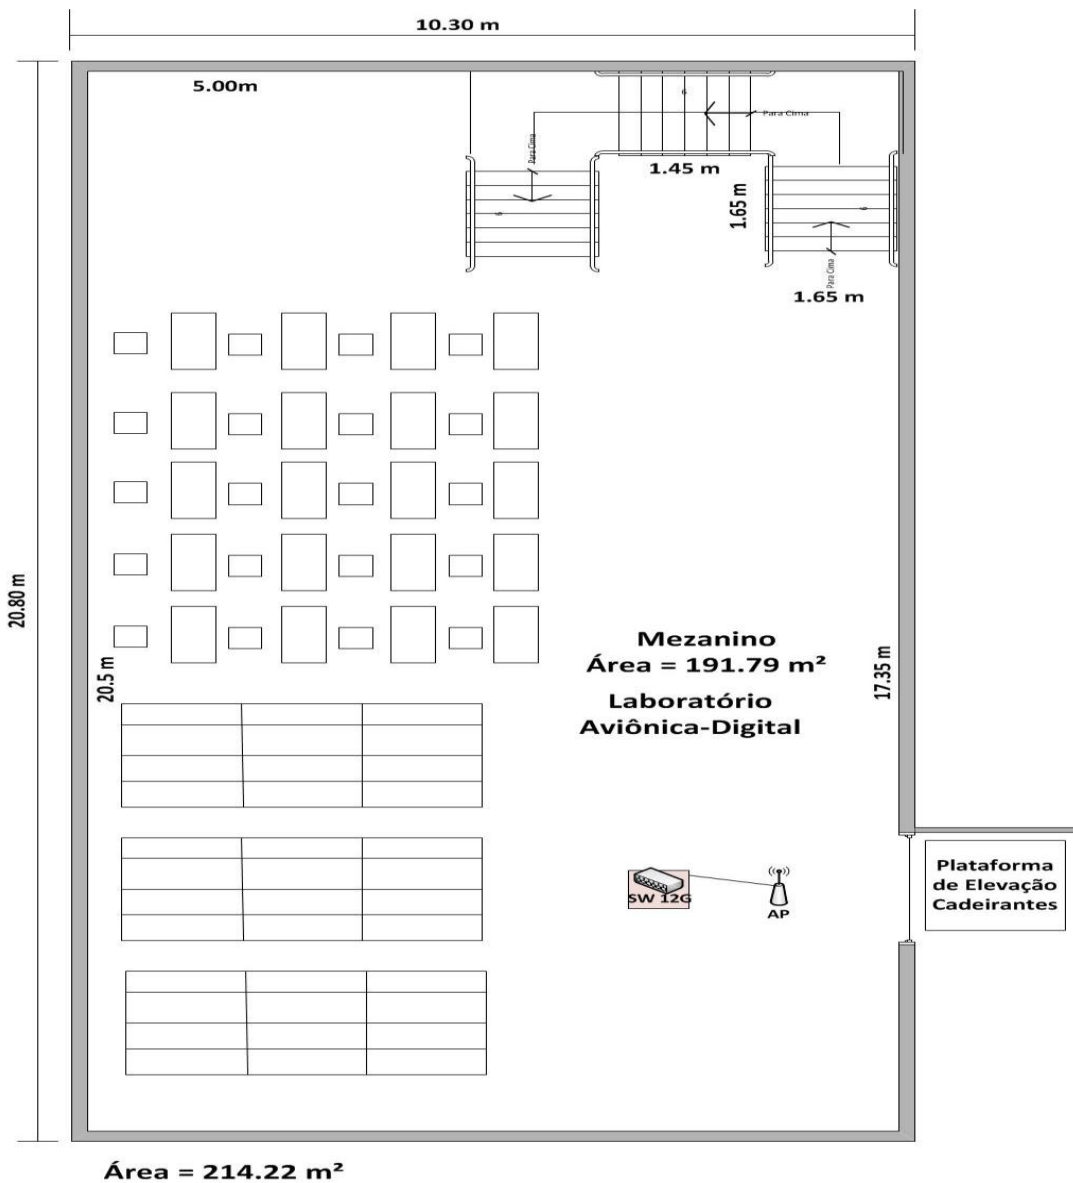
Planta Baixa Mezanino Prédio Oficina
